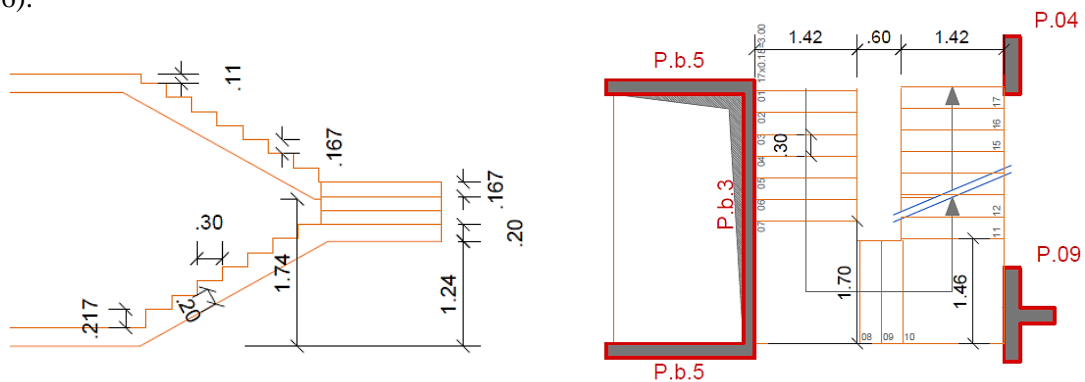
Planta e corte da escada do lote 6.5, piso 0 ao 8.
